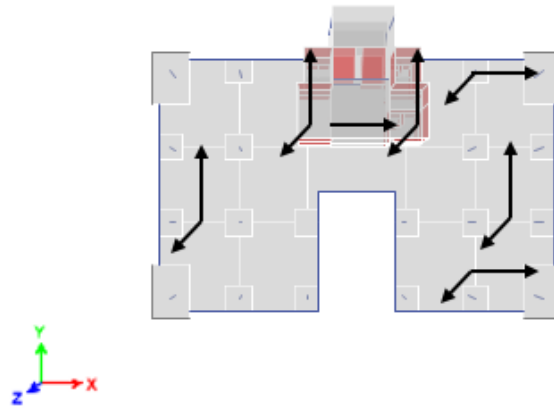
Esquema de ubicación de sensores en la Octava planta y terraza de la estructura.
